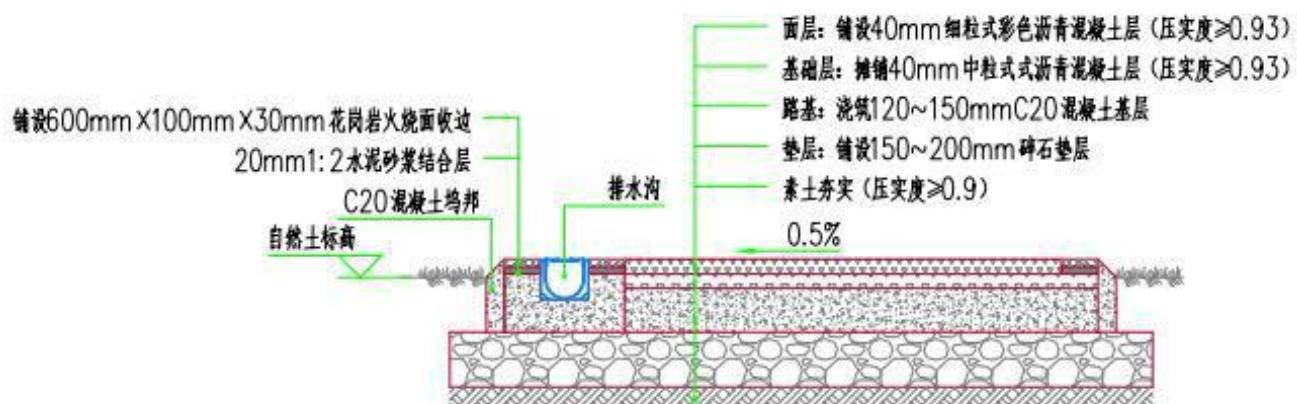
透水沥青混凝土健身步道参考平面图（单向标准段）
